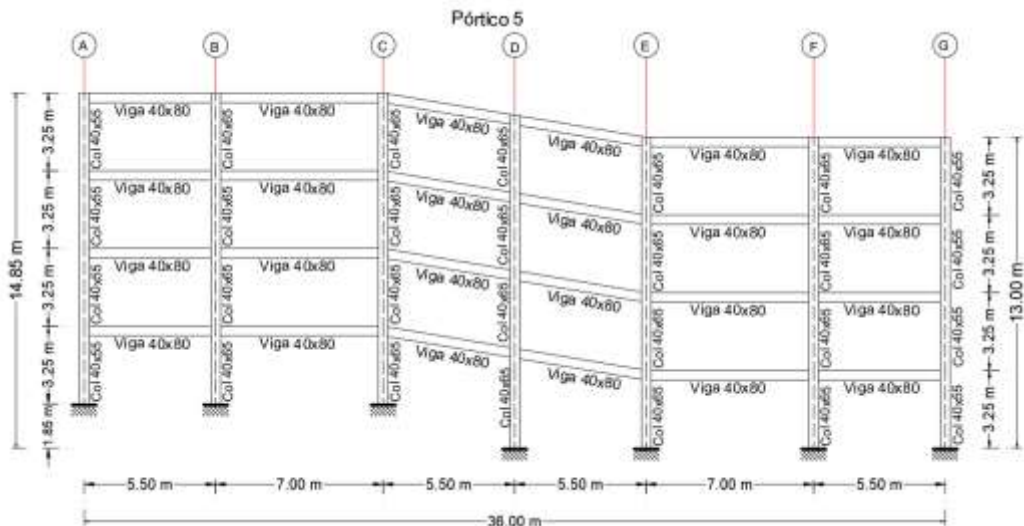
Geometría del Pórtico 5 con vigas inclinadas en la rampa del ex parqueadero.
